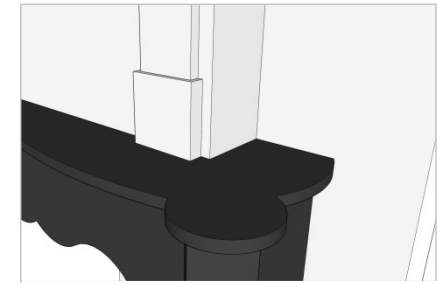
Overzichtsfoto schouw, bijv. foto (7)
